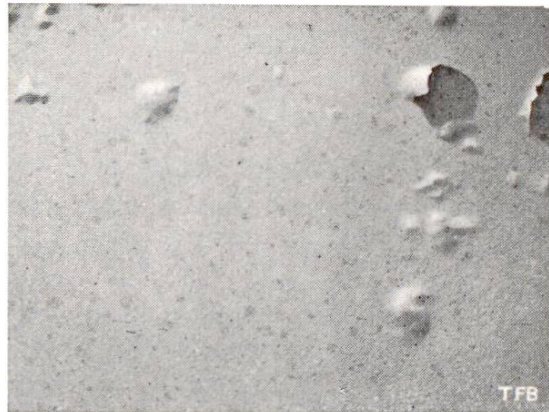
Boursouffures d'une peinture à l'huile surface de base constituée par un enduit au ciment.
